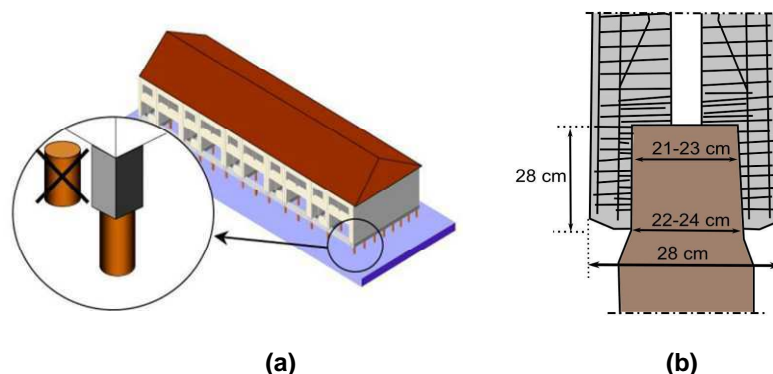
Connexion entre les fondations et la partie supérieure du bâtiment (a) - Dé en béton renforcé par des armatures métalliques en tête des pieux (b) (Stichting Platform Fundering Nederland., 2005 et 2007)
